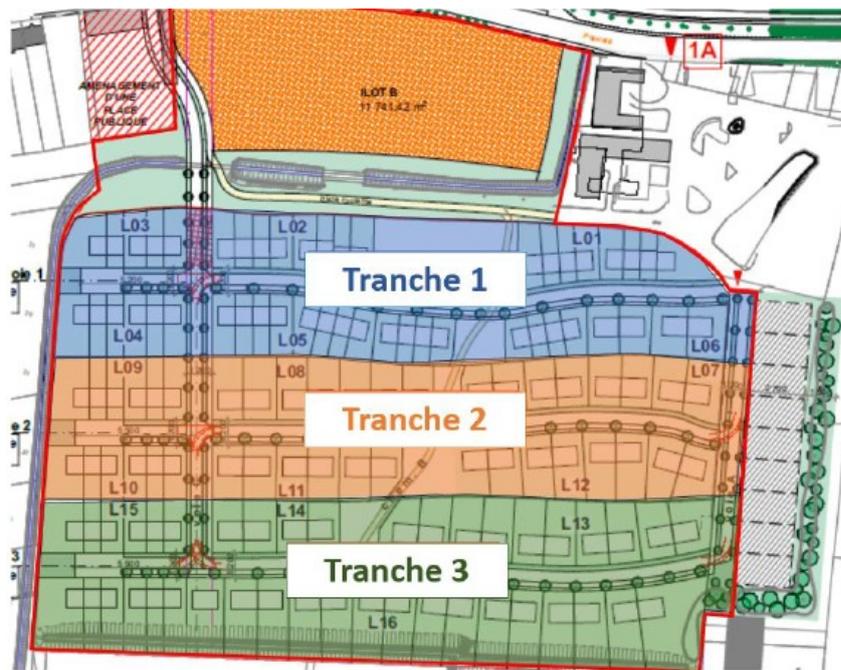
Plan de phasage : tranches 1,2 et 3, et lot B
